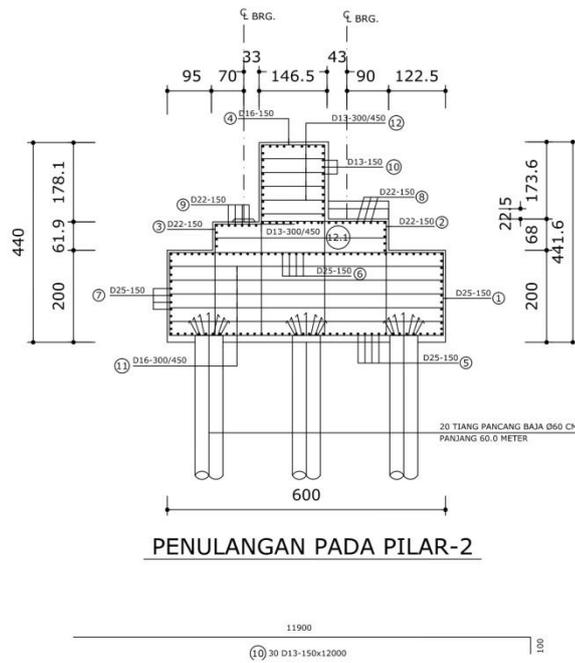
9 Tampak Melintang Tiang Pancang Baja
